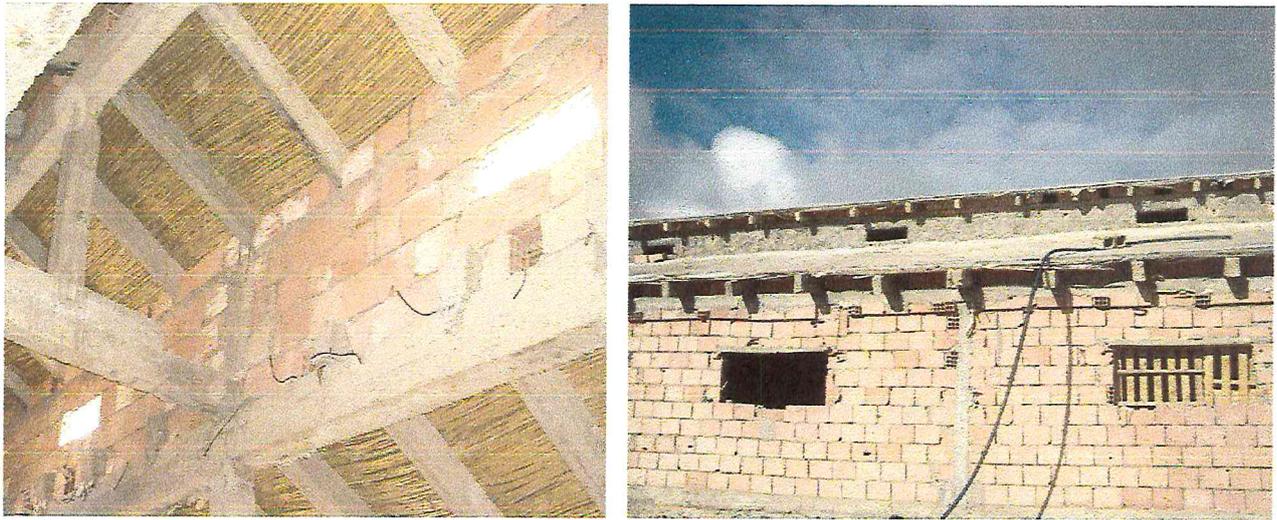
les fenêtres du mur et du toit (photo personnelle 2013).
